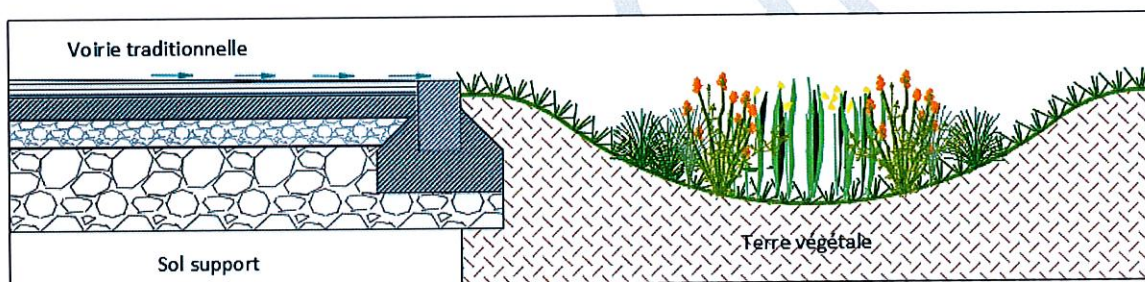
Coupe d'un profil en travers d'un jardin de pluie en cunette (INFRA Services)
